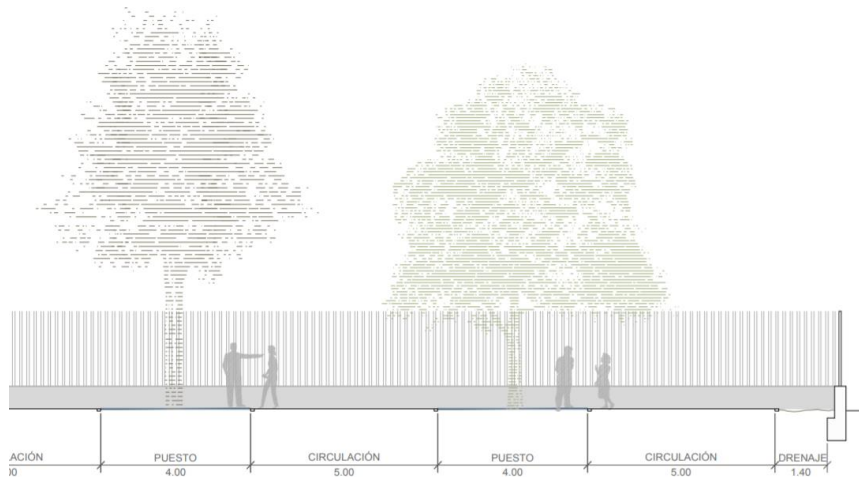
Corte transversal del nuevo rastro. Se observan las zonas de puestos, circulación y drenaje perimetral (derecha).
